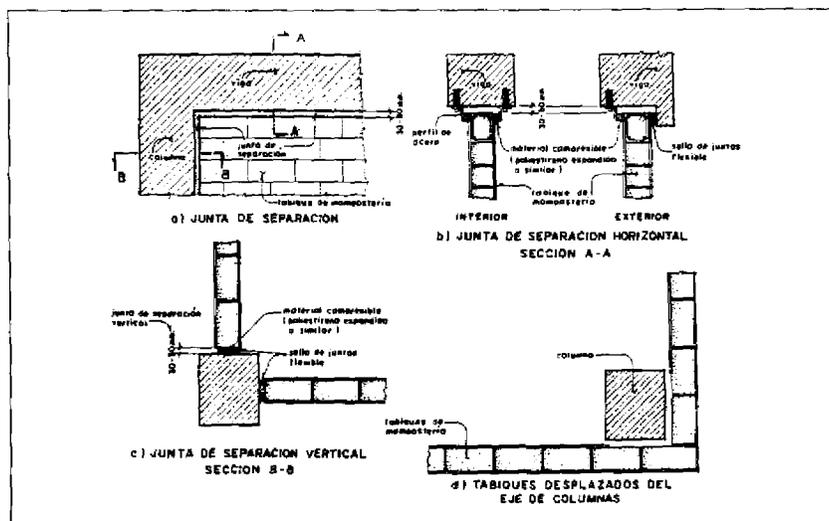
Detalles constructivos tendientes a separar los elementos de mampostería de la estructura - a., b. y c.) Juntas de separación verticales y horizontales - d.) Tabiques desplazados del eje de las columnas.
